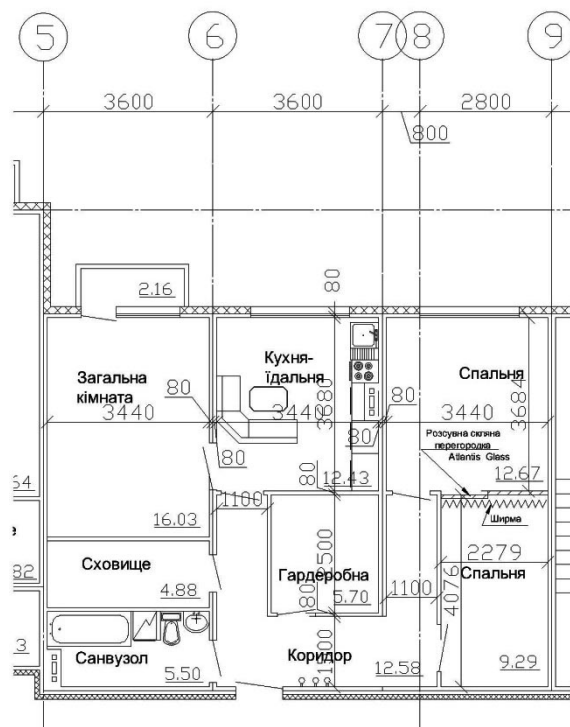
Планувальне рішення трьохкімнатної квартири, яка розташована між осями 5 – 9
